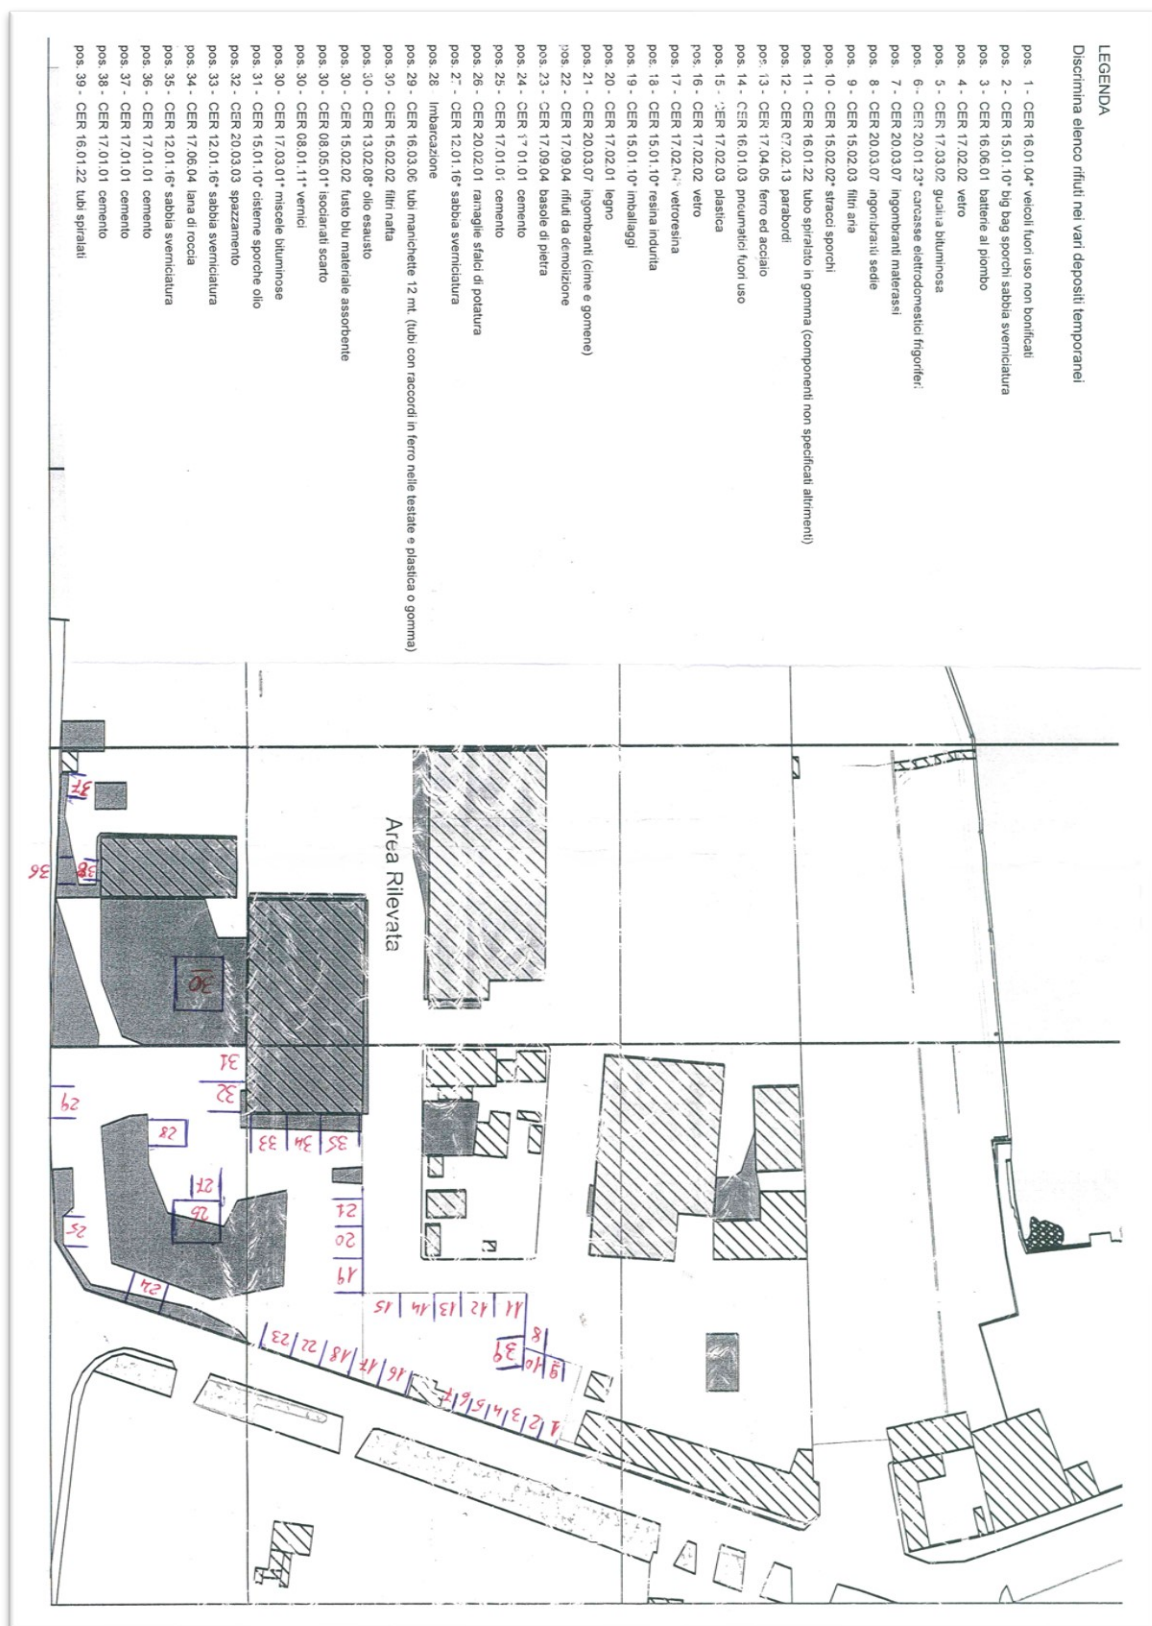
Planimetria dei depositi temporanei redatta dalla ditta Geom. Giuseppe Mistretta
